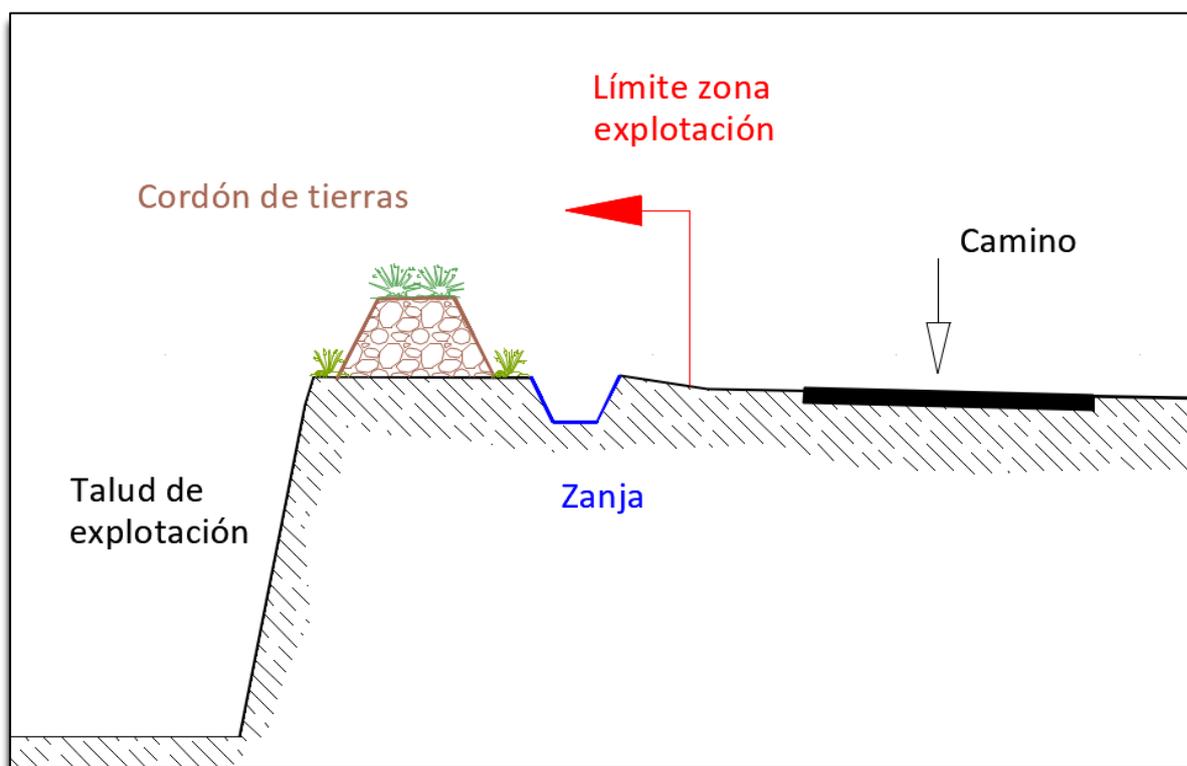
Esquema tipo del perímetro del hueco de excavación. Alzado.
